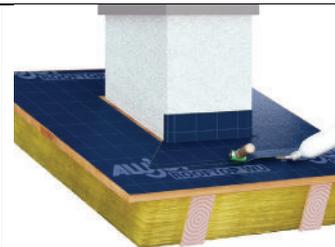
Ausführung verschweißen an aufgehendem Bauteil
